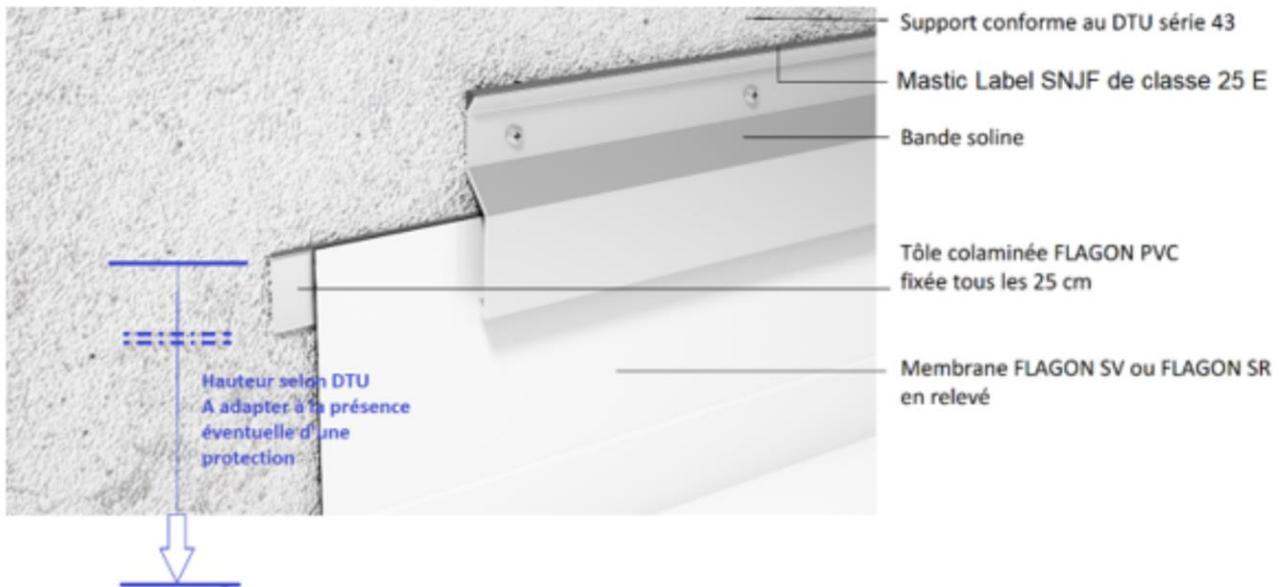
bis – Détail sur finition par soudure en tête de relevé sur profil de serrage
